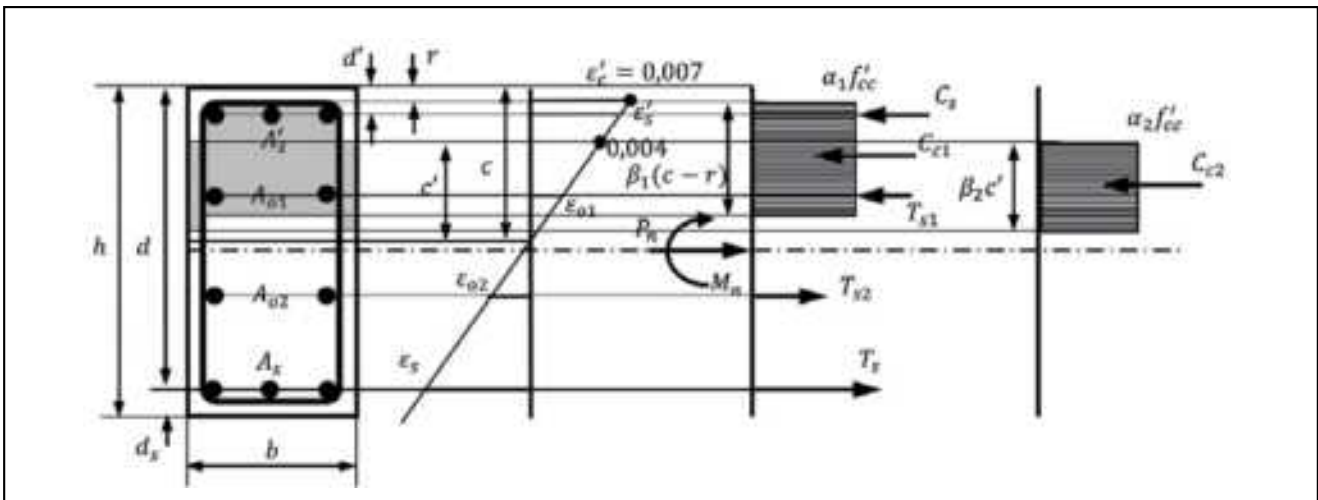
Diagrama de deformaciones, tensiones y fuerzas en columnas confinadas.
